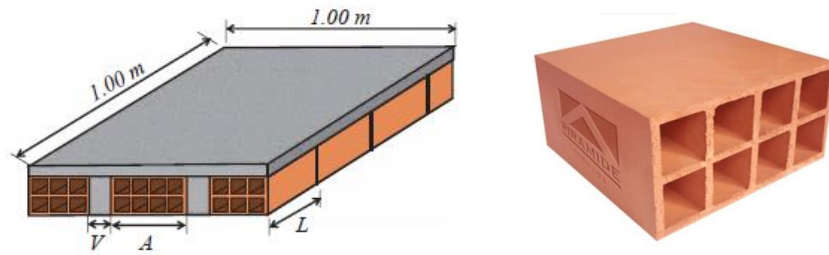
38 Sección de losa aligerada - Ladrillo por m² de Techo
